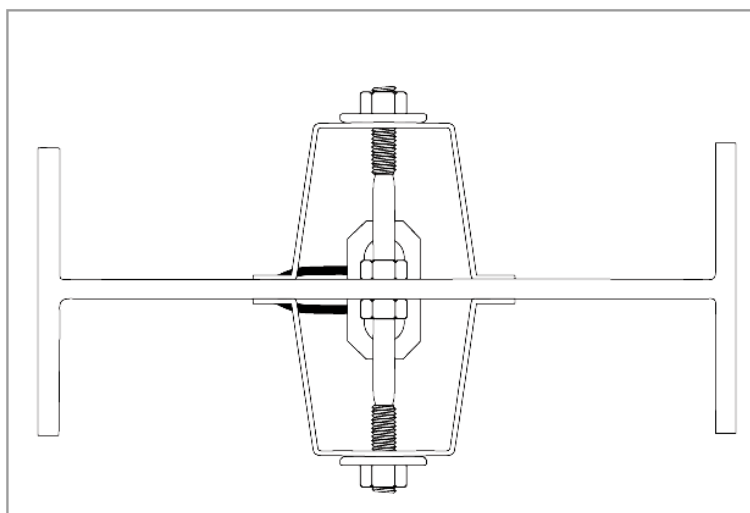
Установка закрывающей плиты. Вид сбоку.
